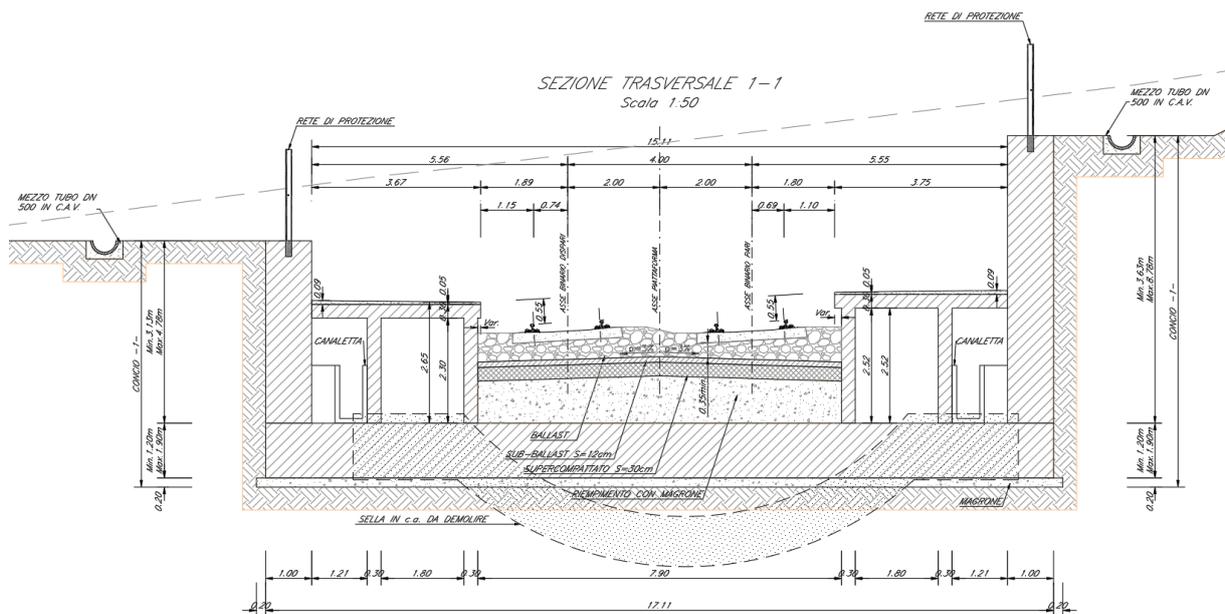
Sezione trasversale muro ad U (concio 2) – Grottaminarda lato Bari
